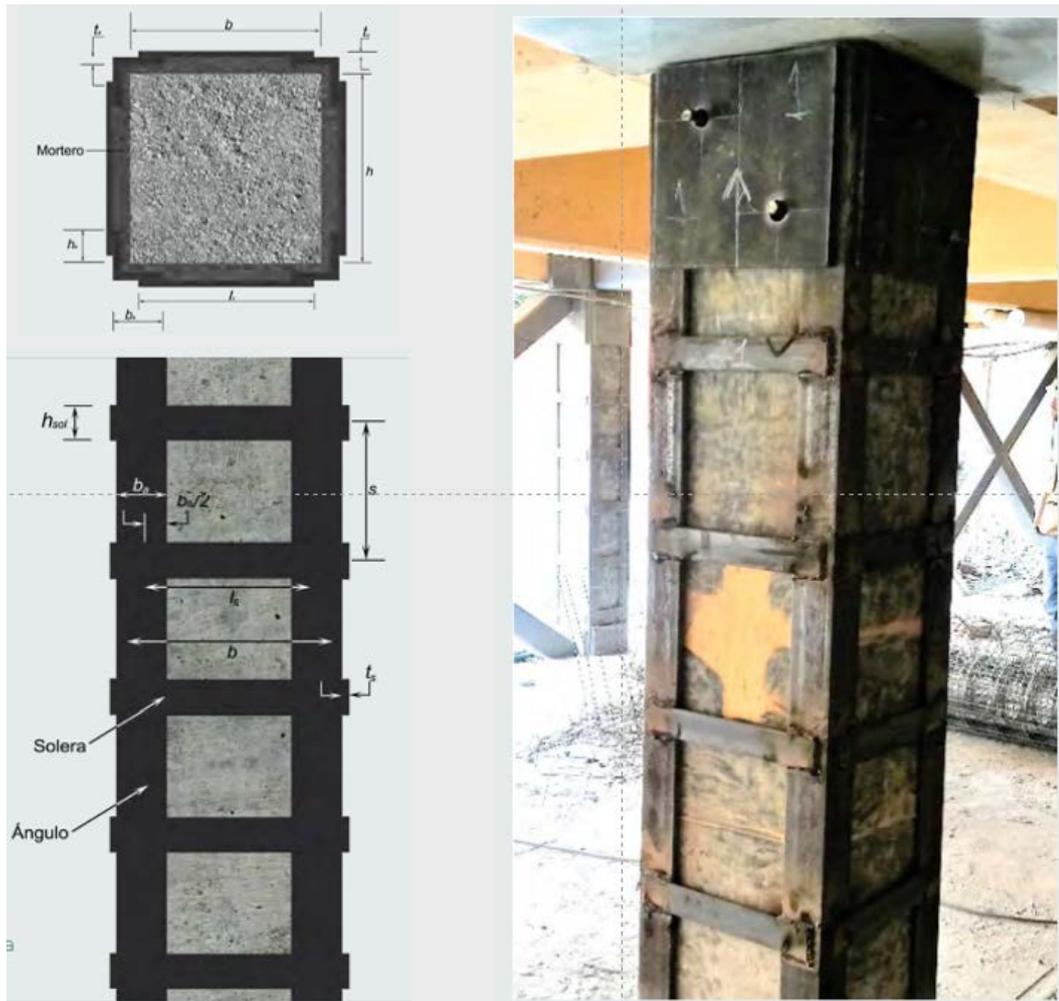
Encasamiento de pilar de hormigón armado, mediante angulares y pletinas de acero. Fuente: (Alcocer and Murià, 2021).
